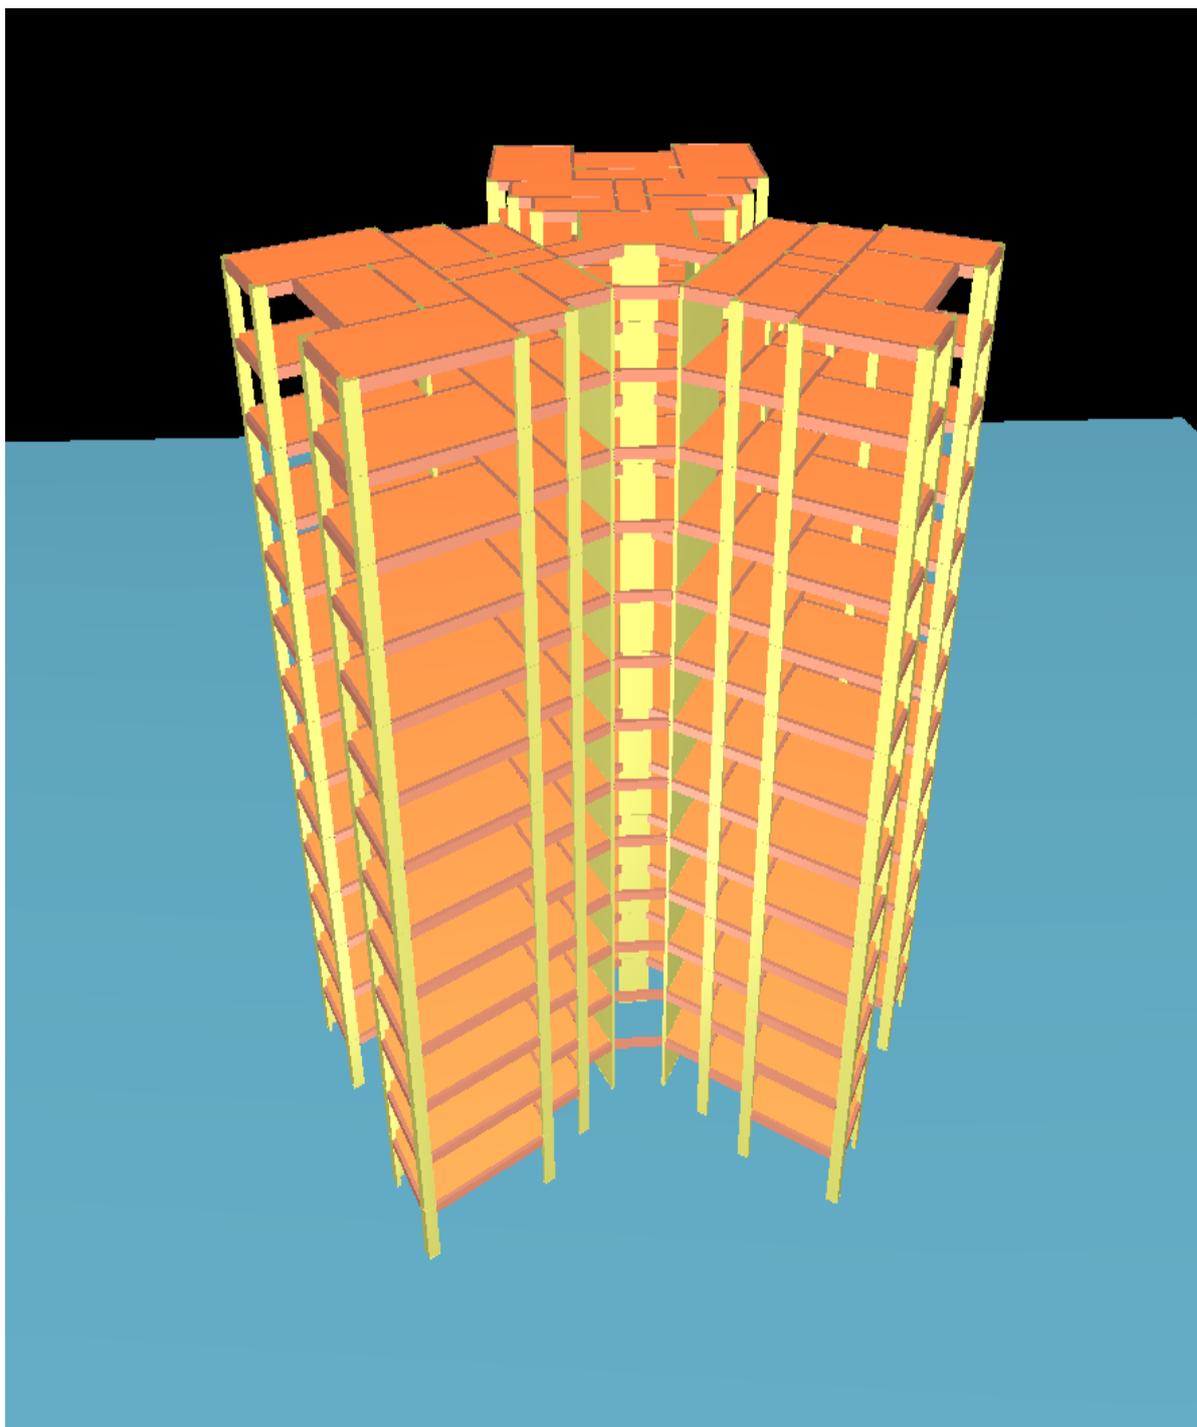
Modelo estrutural pavimento tipo concreto armado
